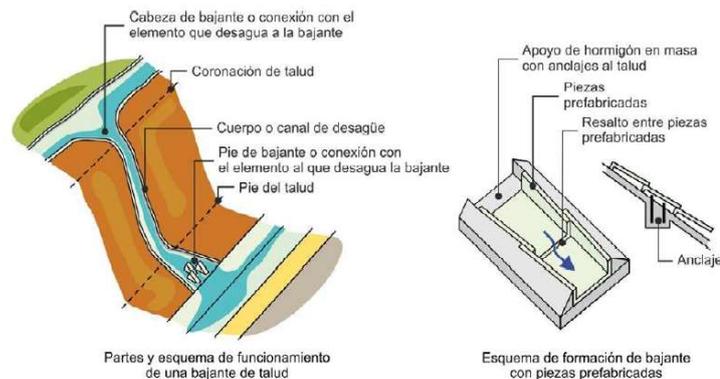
Esquema de bajante (Norma 5.2-IC)
